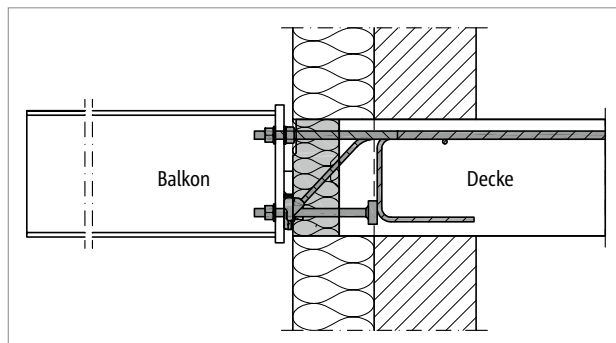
Schöck Isokorb® T Typ SKP: Dämmkörper schliesst mit Hilfe des Deckenvorsprungs aussen bündig mit der Dämmung der Wand ab, dabei sind die seitlichen Randabstände zu beachten
